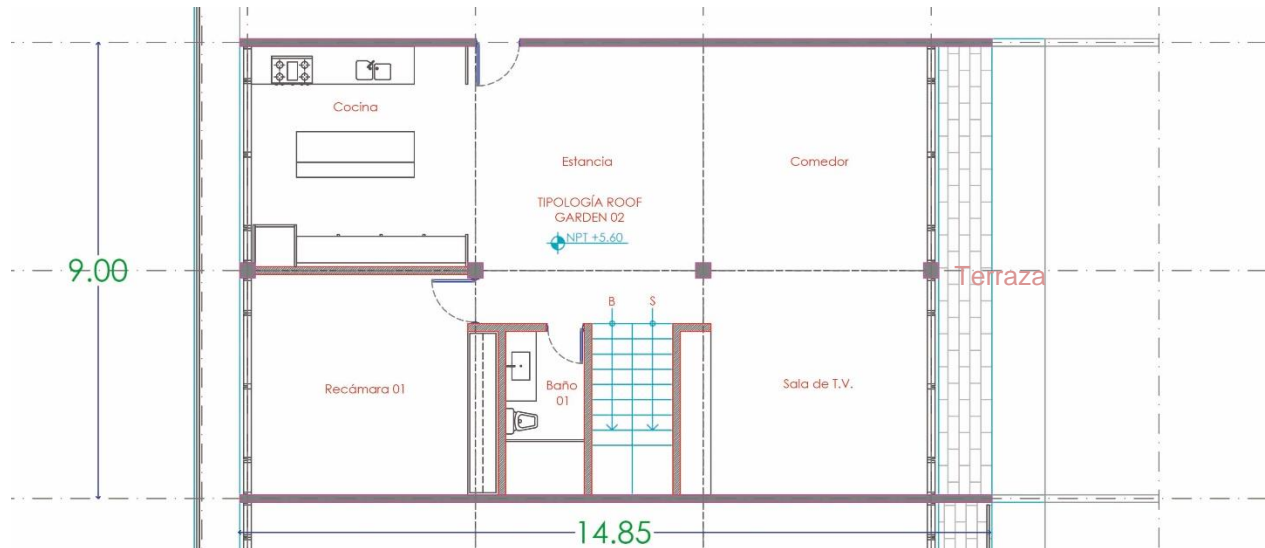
Se muestran los compartimentos de la Villa Roof Garden tipo 2 en planta alta.
